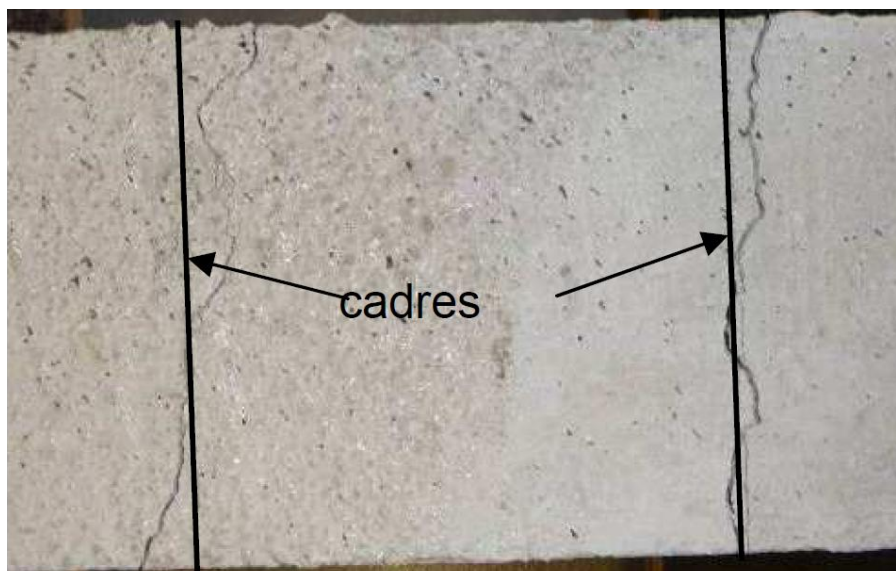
Fissuration externe sur poutre HA8B flexion 3 pts alternée, essais CEA/LMT (Crambuer et al 2011)
